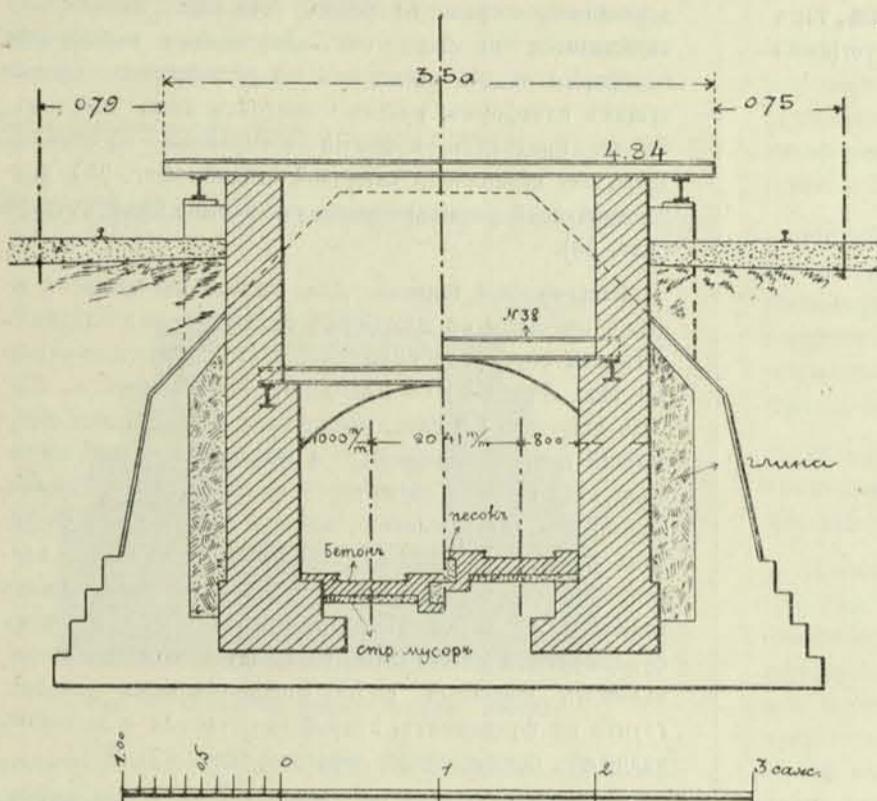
Продольный разрез поперечного багажного тоннеля.
